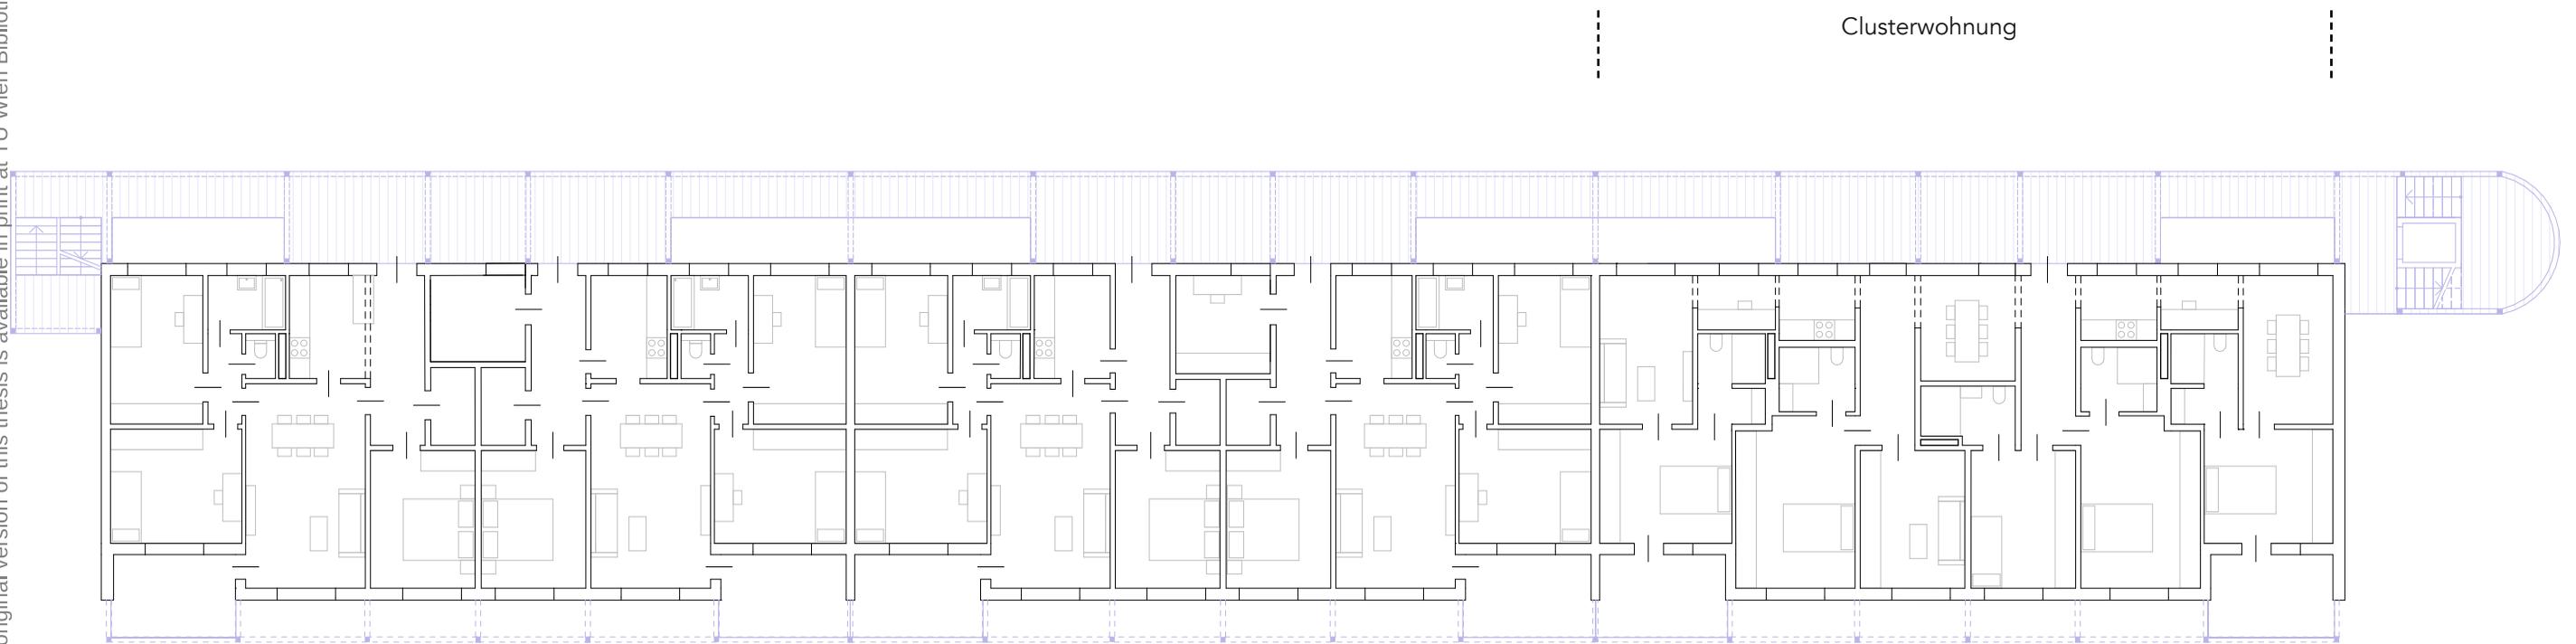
Grundriss Regelgeschoss M 1:200
